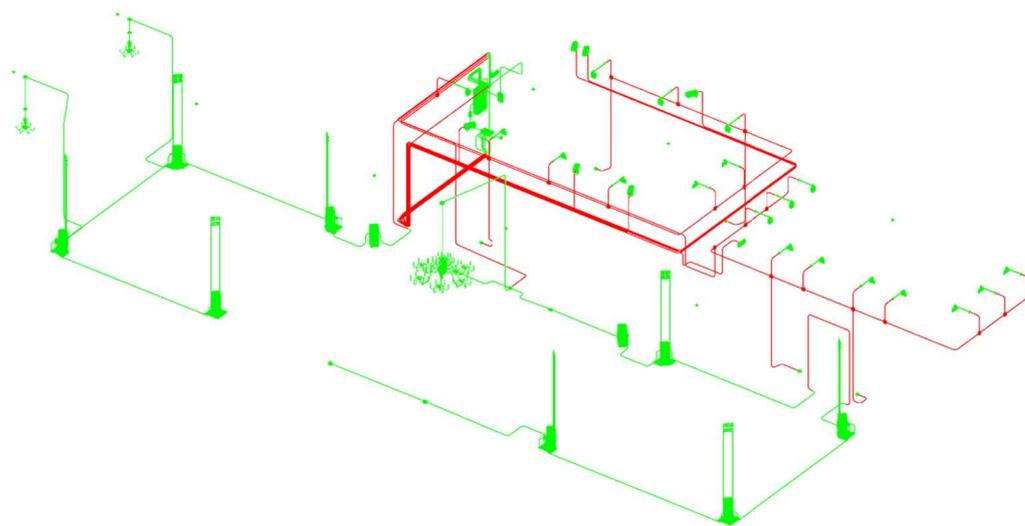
Vista assonometrica ortogonale degli elementi impiantistici rilevati e non rilevati.
